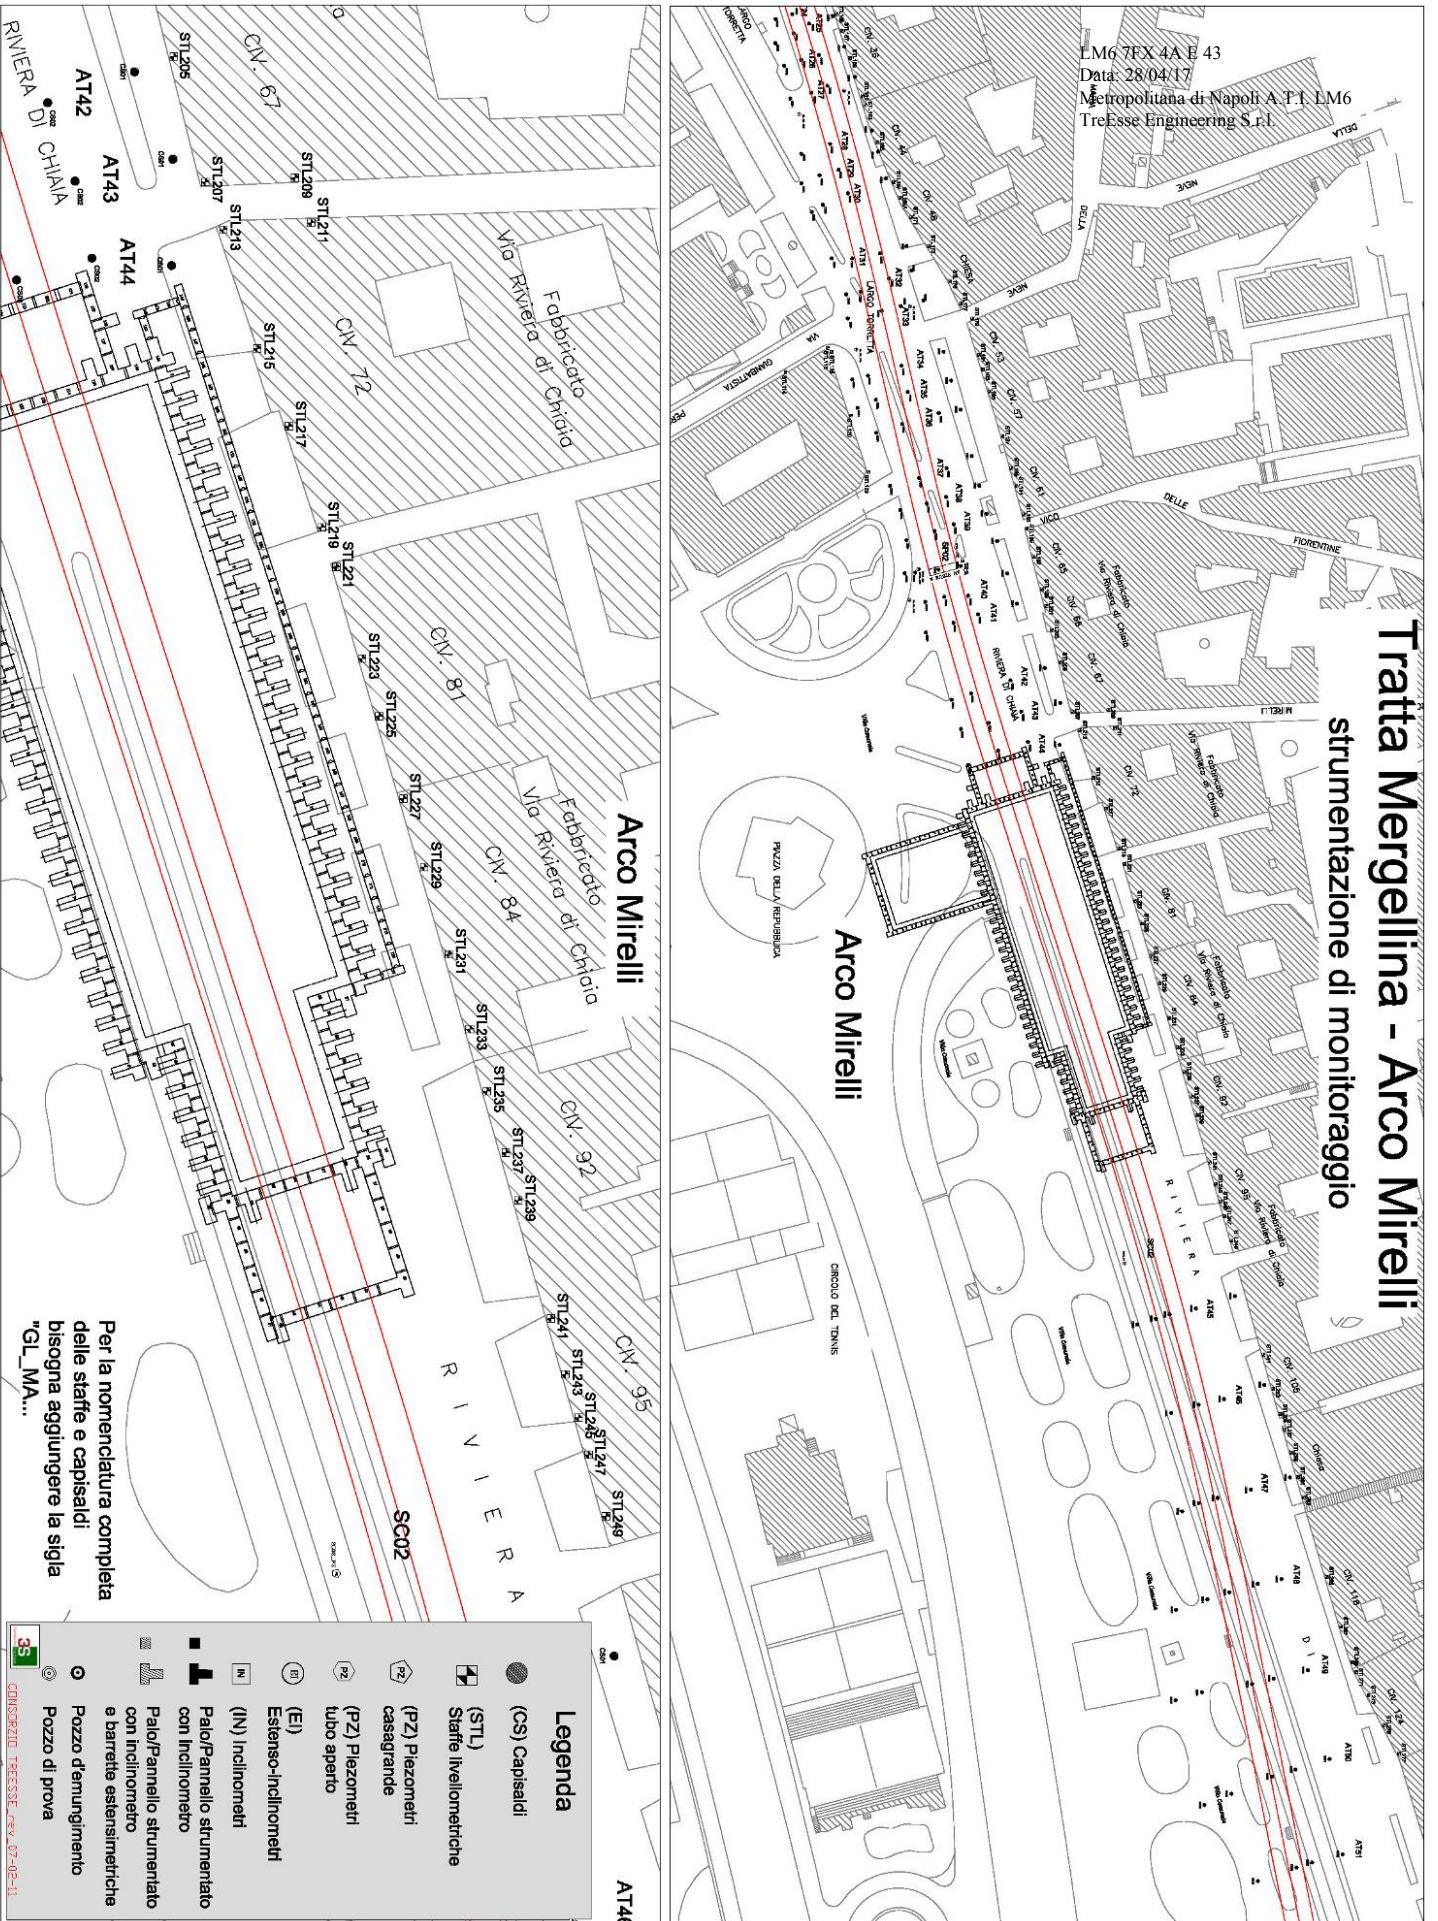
Planimetria tratta Mergellina - Arco Mirelli, raffigurante la disposizione della strumentazione di monitoraggio in corrispondenza della stazione Arco Mirelli.
